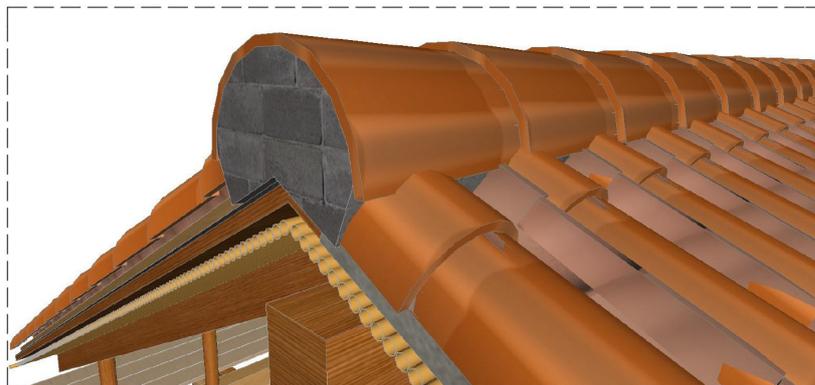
Detalles de la cubierta, vista frontal
